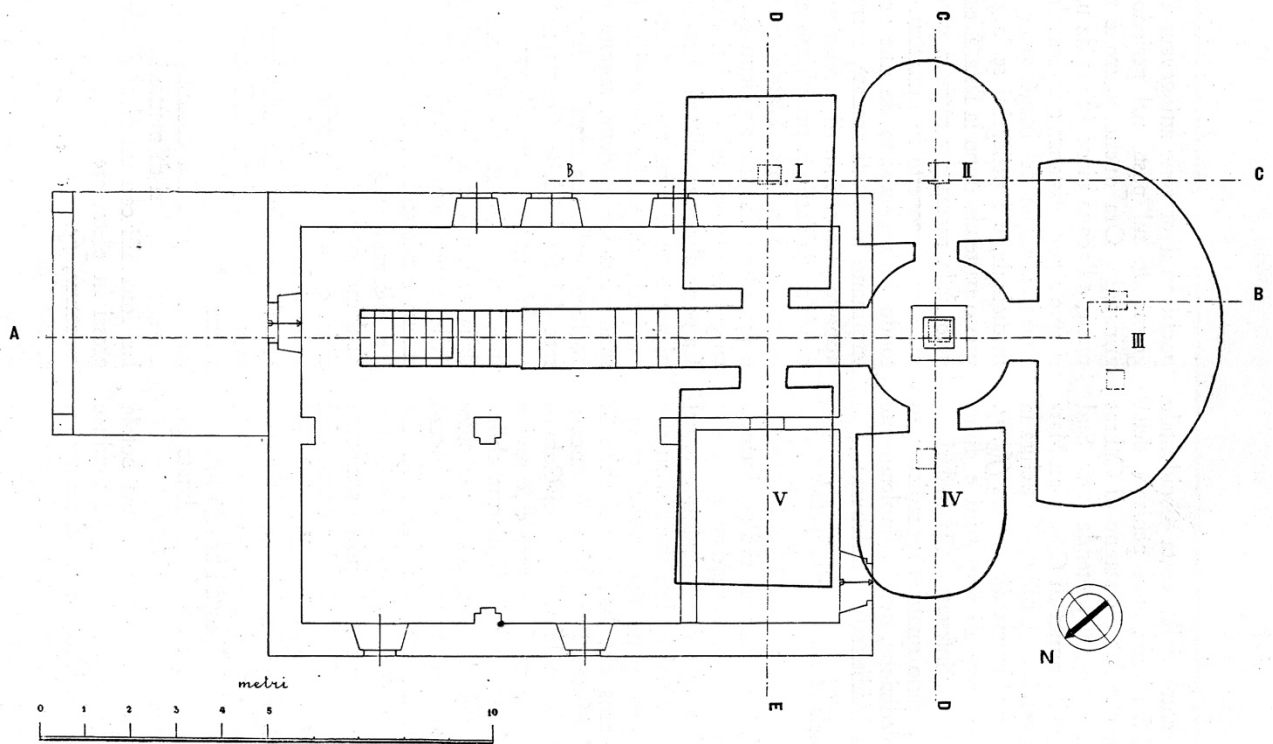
San Salvatore di Cabras, Hypogäum. Grundriss (aus: LEVI 1959)
